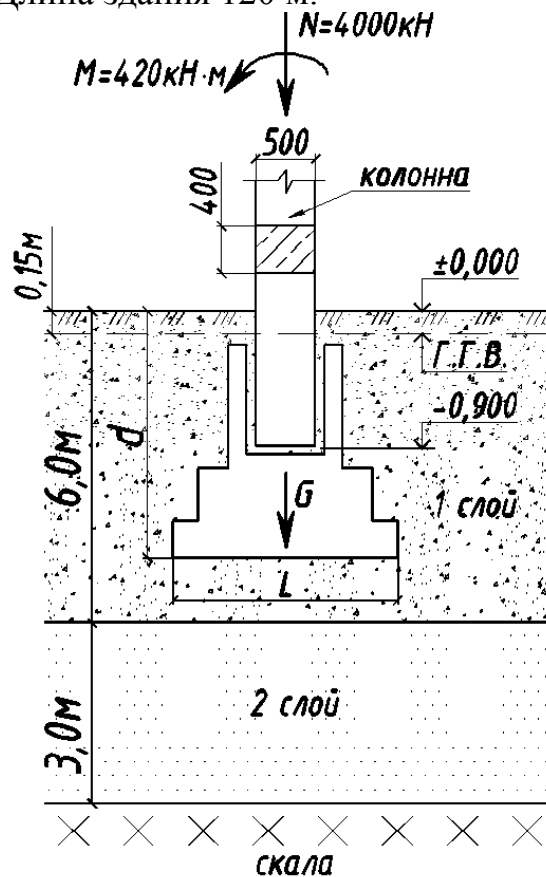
Нагрузки на колонну по оси А и схема напластования грунтов
